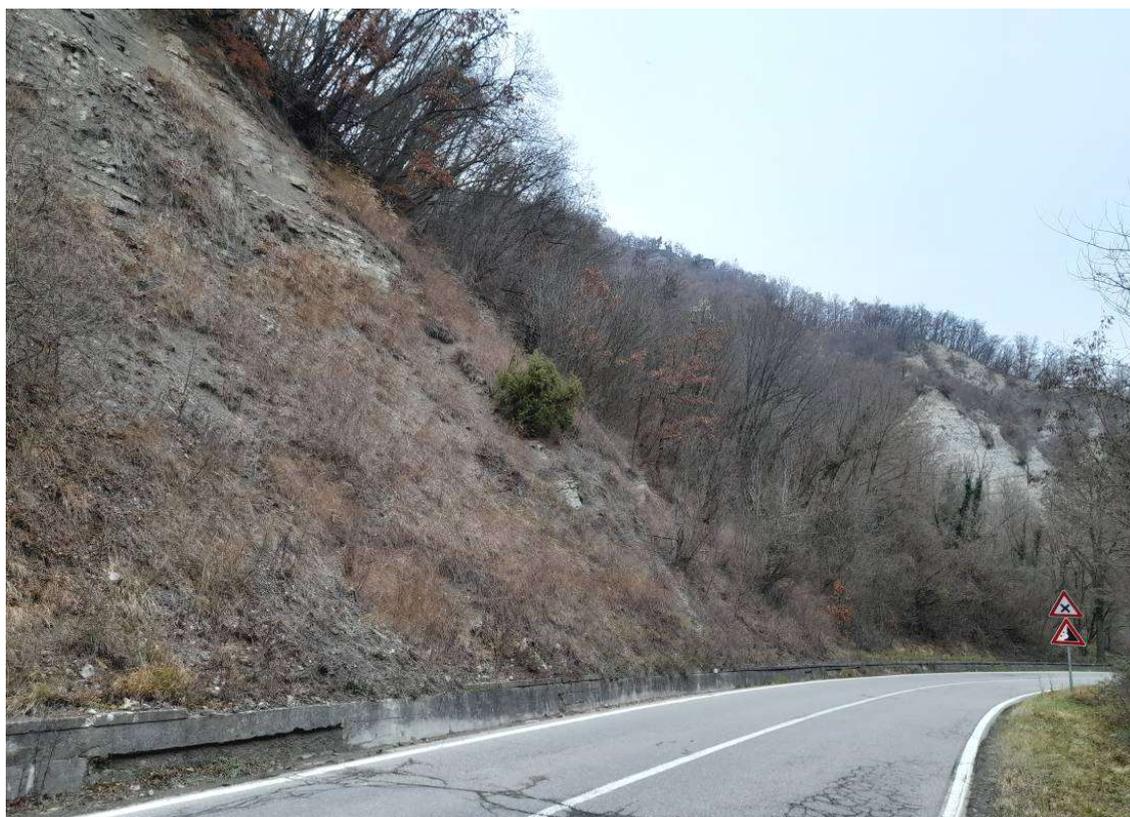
Vista del versante con accumuli del materiale franato alla base dello stesso
